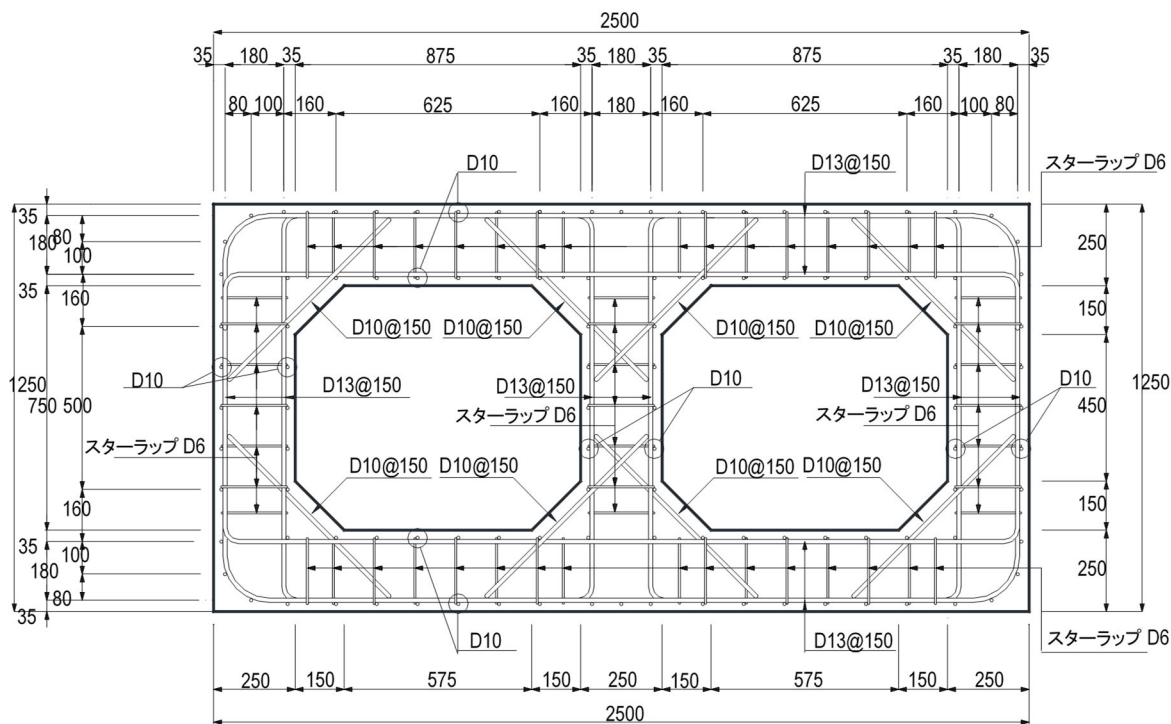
試験体の配筋図（実構造物の1/4縮尺）
